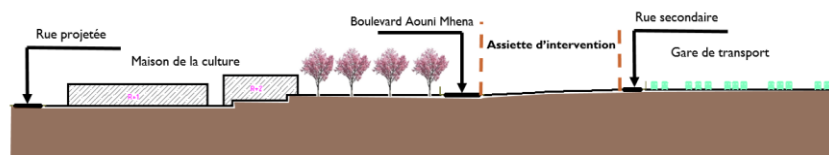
Coupe BB sur l'assiette d'intervention.
